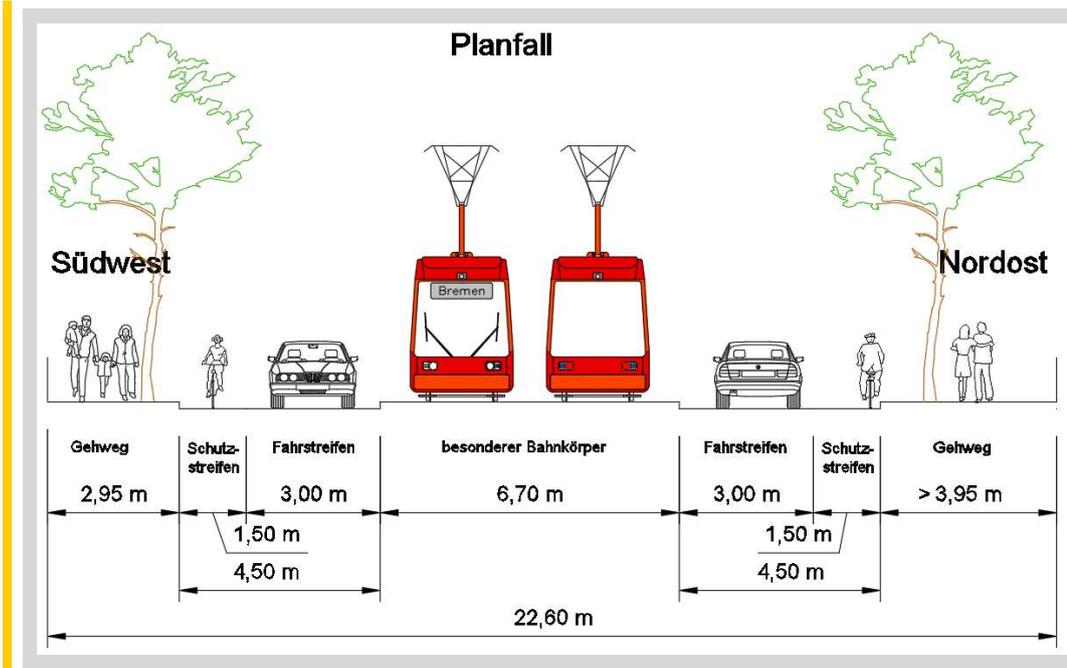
Hoerneckestraße Nord – Querschnitt Planfall
